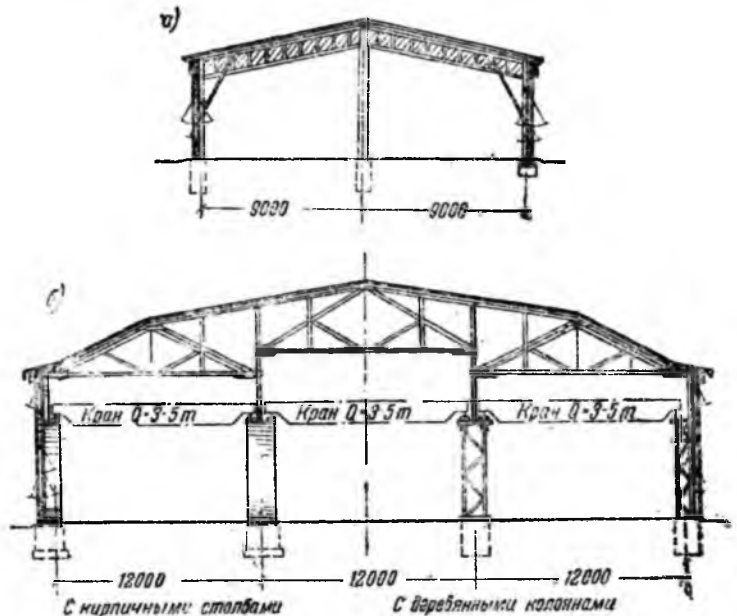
Схемы разрезов упрощенных двух- и трехпролетных производственных зданий с деревянными покрытиями
